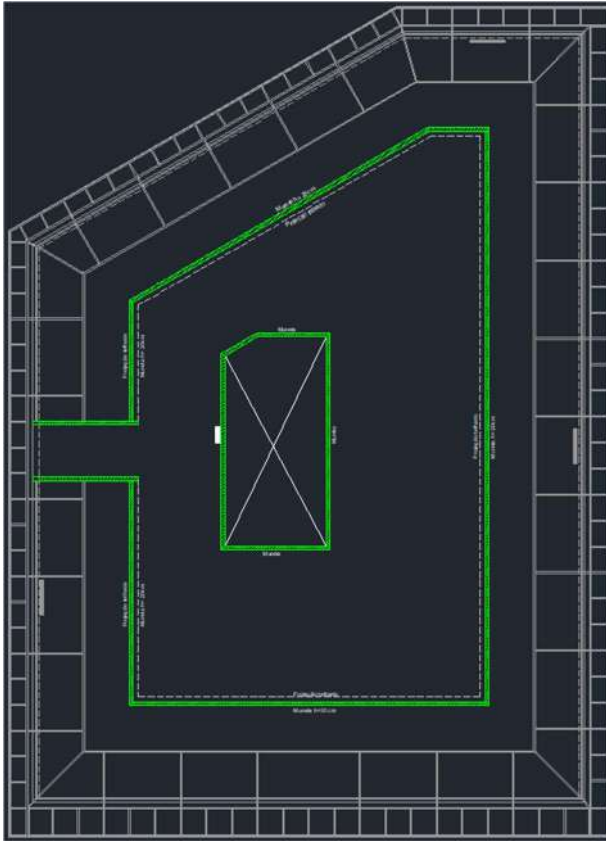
Alvenaria cobertura – Planta baixa Bloco C
